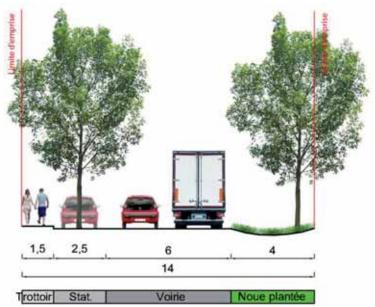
Profil type des voies tertiaires : profil 3 : avec stationnement
